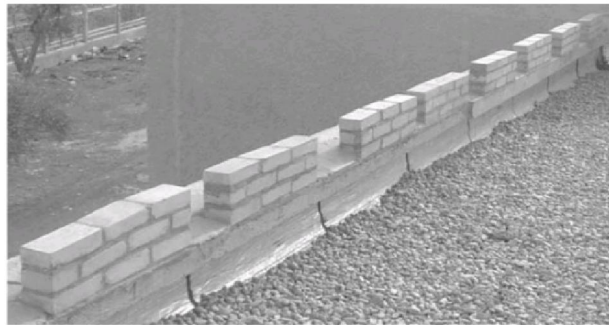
Vue générale des murs construits (A.Guettala, A.Abibsi, & H.Houari, 2006)
